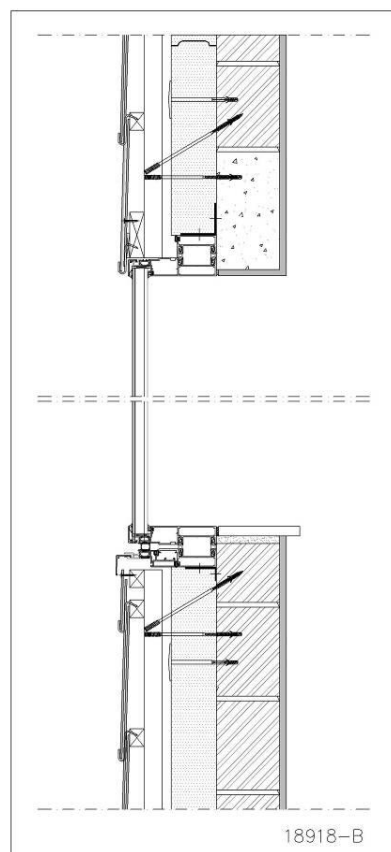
Exemple coupe verticale d'une fenêtre dans le même plan de la façade
